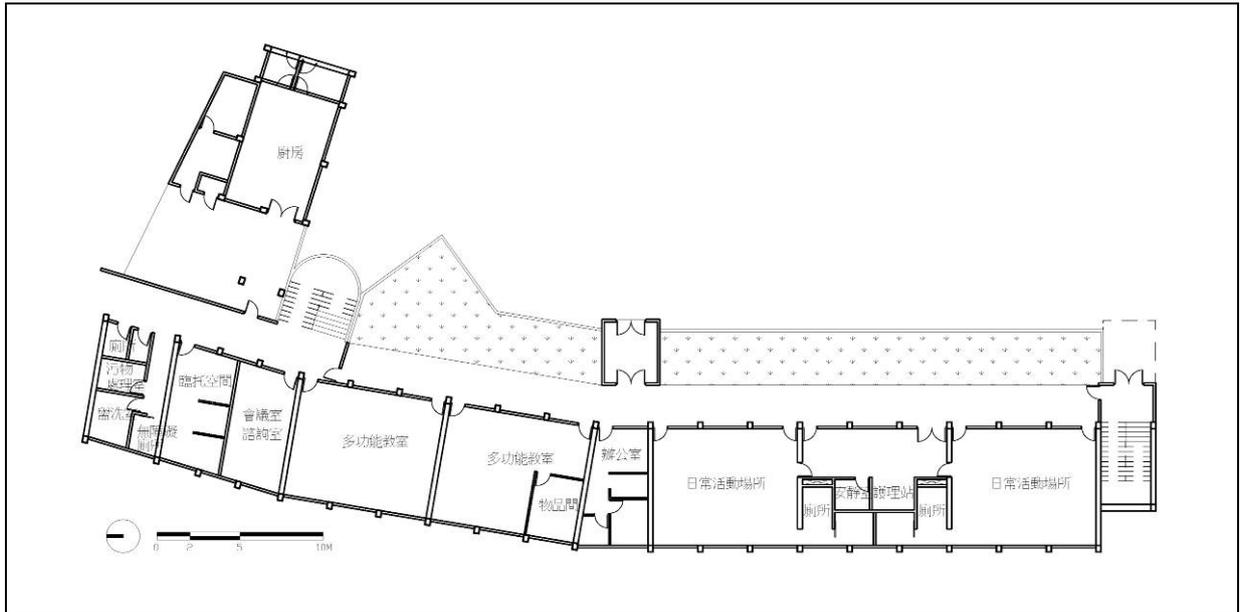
台東縣私立耆福綜合式長照機構平面圖
